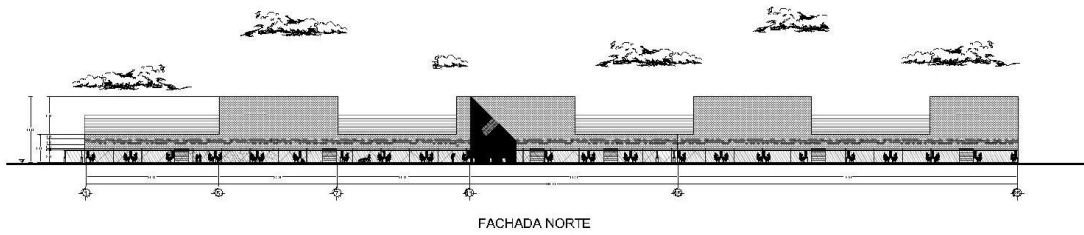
Propuesta de Fachada Vista Norte, Mercado Independencia
